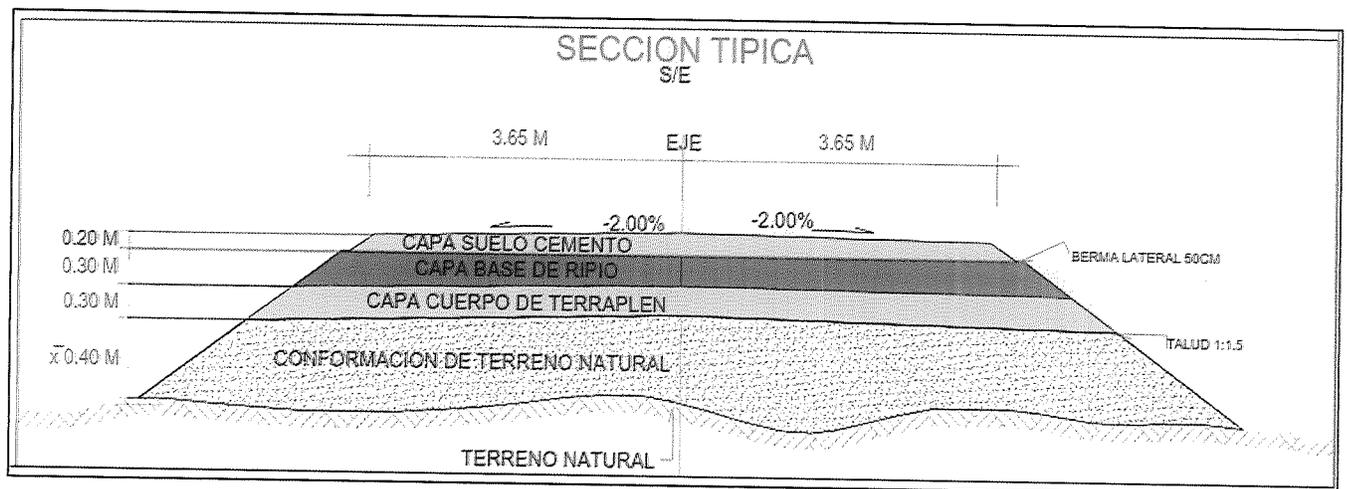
Detalle Sección Transversal de la estructura a conformar
